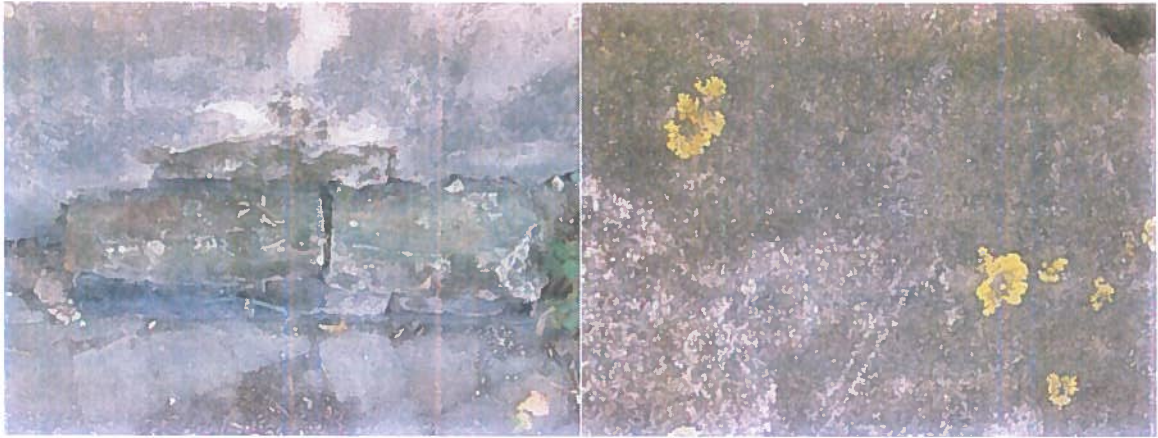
Zniszczenia tynku na elewacji południowej w rejonie zwieńczenia bramy (fot. lewa) oraz pasa pod furką flankującą (fot. prawa).
